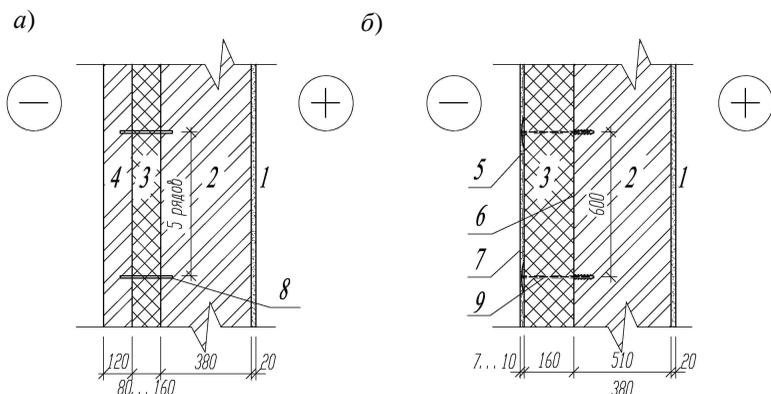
Схемы устройства слоистой кладки наружных стен:
